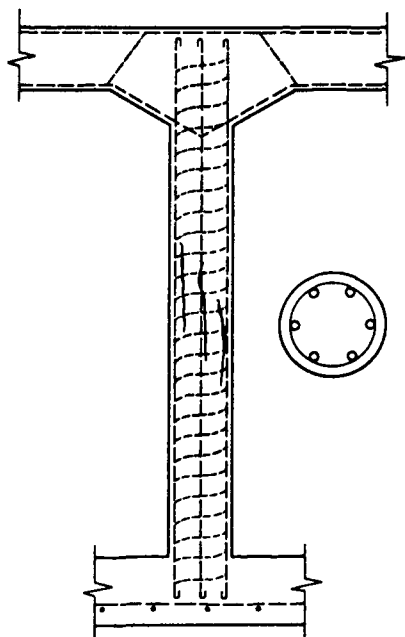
Columna zunchada comprimida. Grietas antes de la rotura, según Bukowski¹.
